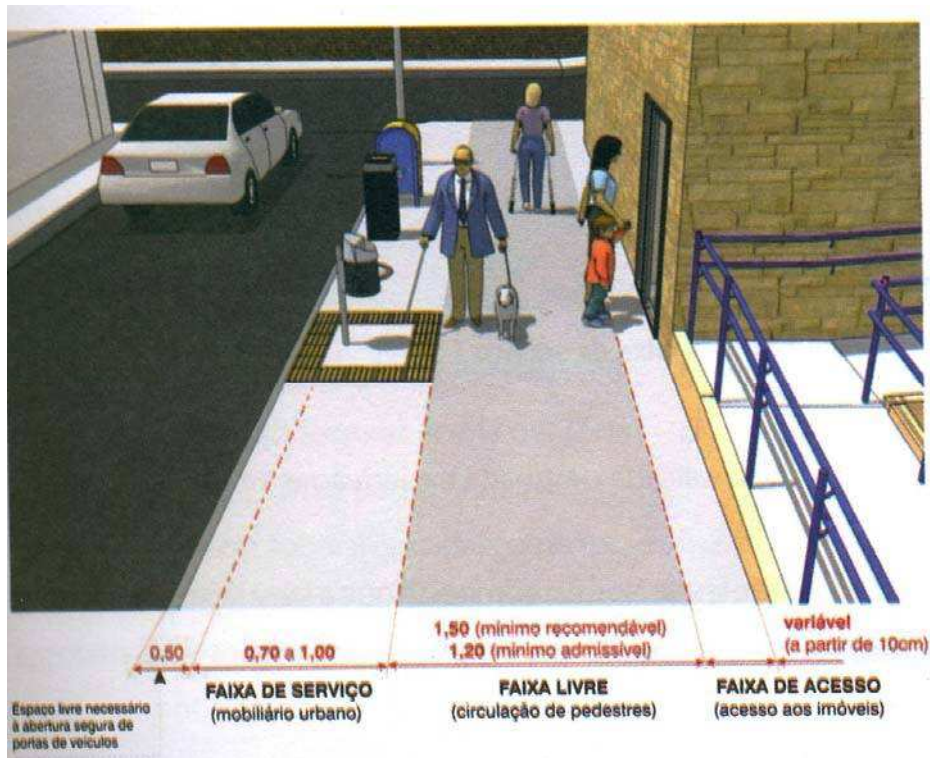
Dimensionamento ideal para faixas de utilização da calçada.
